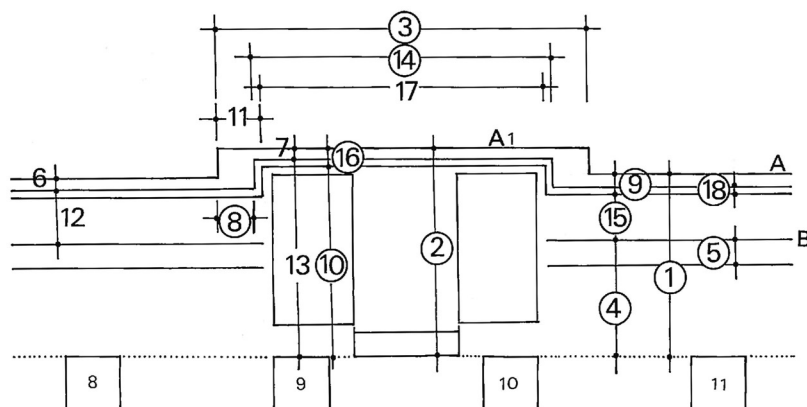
Processus de mise en place des marches et du caniveau au droit du Perron sud (G. Hallier).
